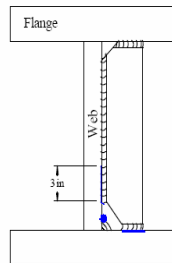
Quersteife an Flansch durchgeschweißt
